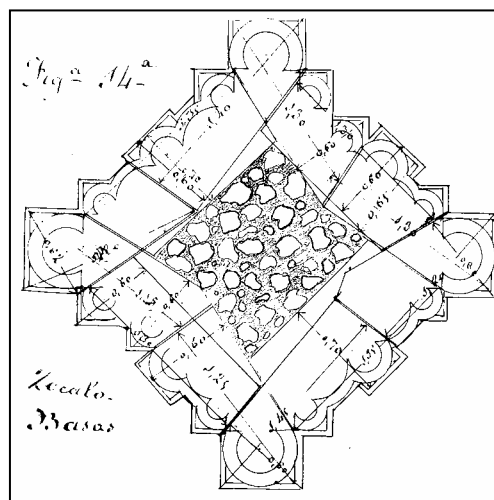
Sección de un pilar de la nave de la catedral de León
